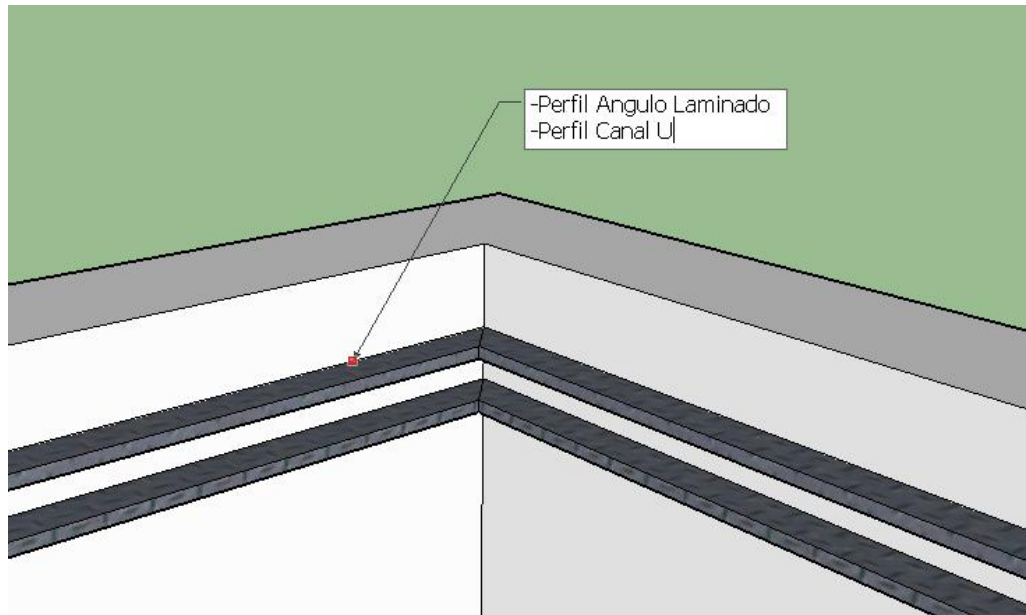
Perfiles soportantes de la estructura a armar.
